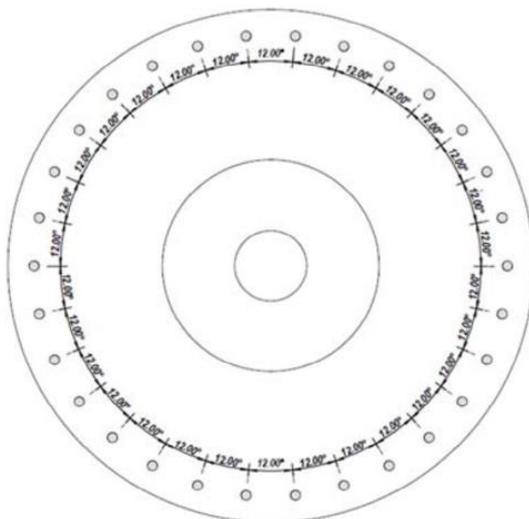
Andamento geometrico della fondazione (pianta – non in scala).
